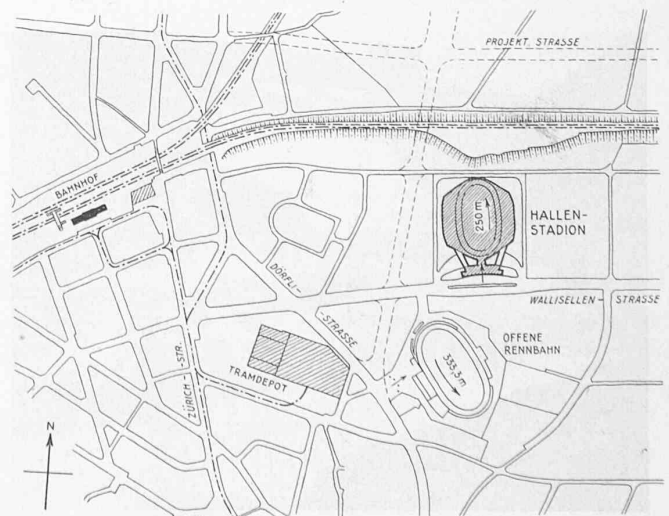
Lageplan des Hallenstadions in Zürich-Oerlikon — 1 : 10000
